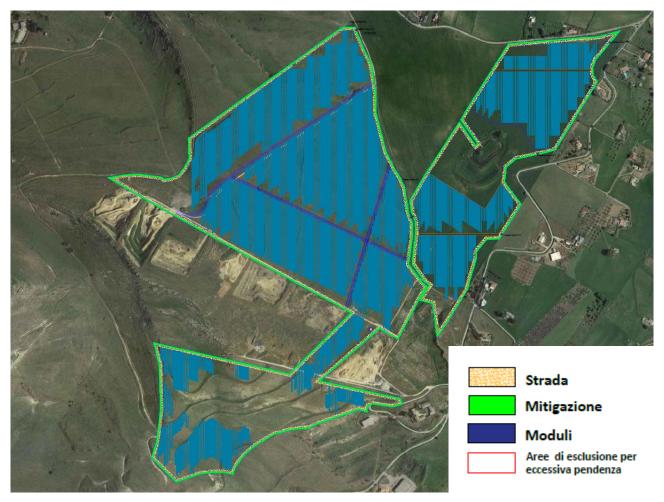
VISTA DALL'ALTO DEL TERRENO: STATO DI PROGETTO
